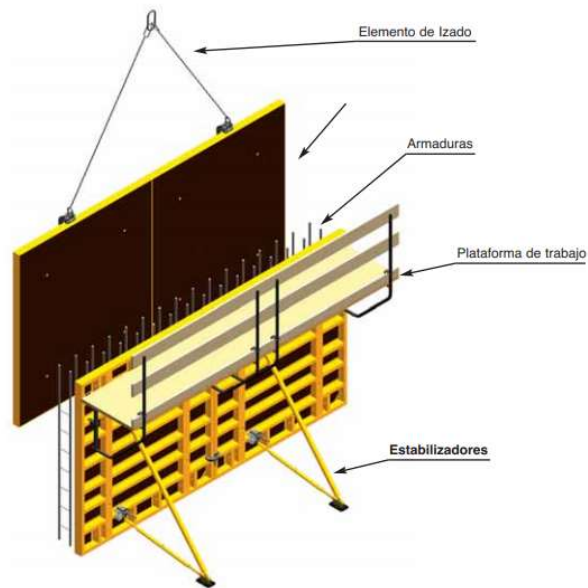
Encofrado de Placas (Guía práctica de encofrados, 2018)
